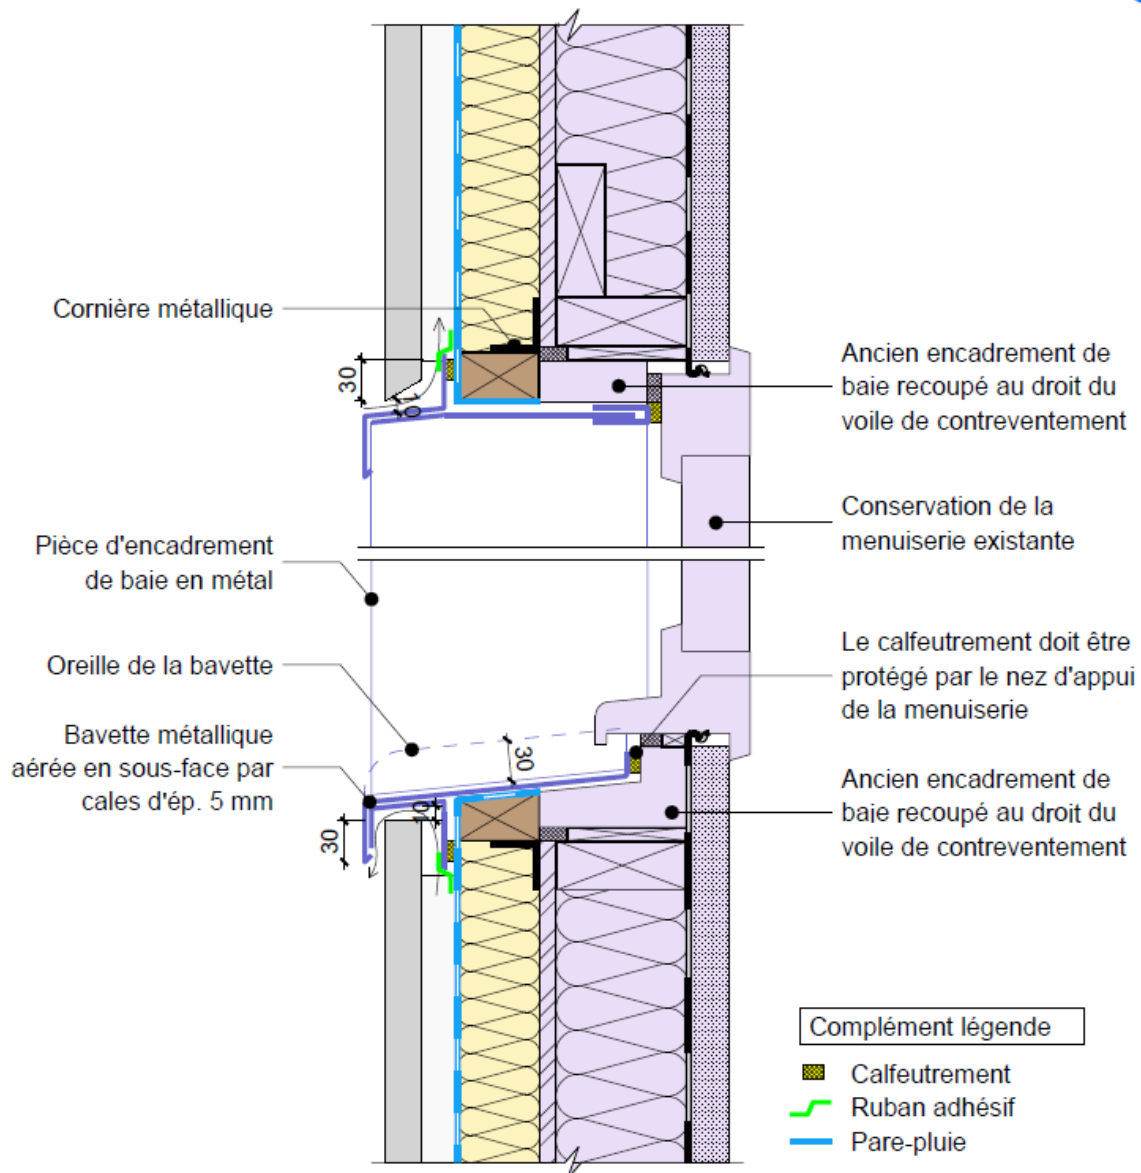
Baie avec encadrement rapporté en métal (coupe verticale)
